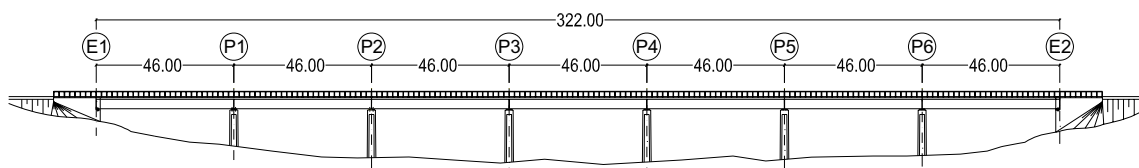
Perfil longitudinal do viaduto del Genil
